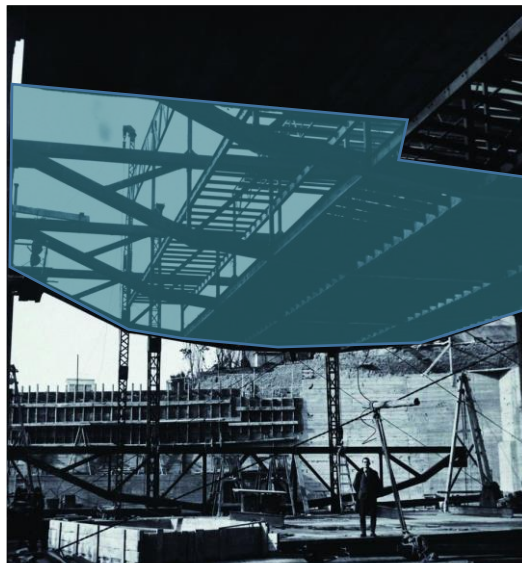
Construcción - Estructura. (Fuente: <https://www.archdaily.pe> – fotografía de la estructura)
